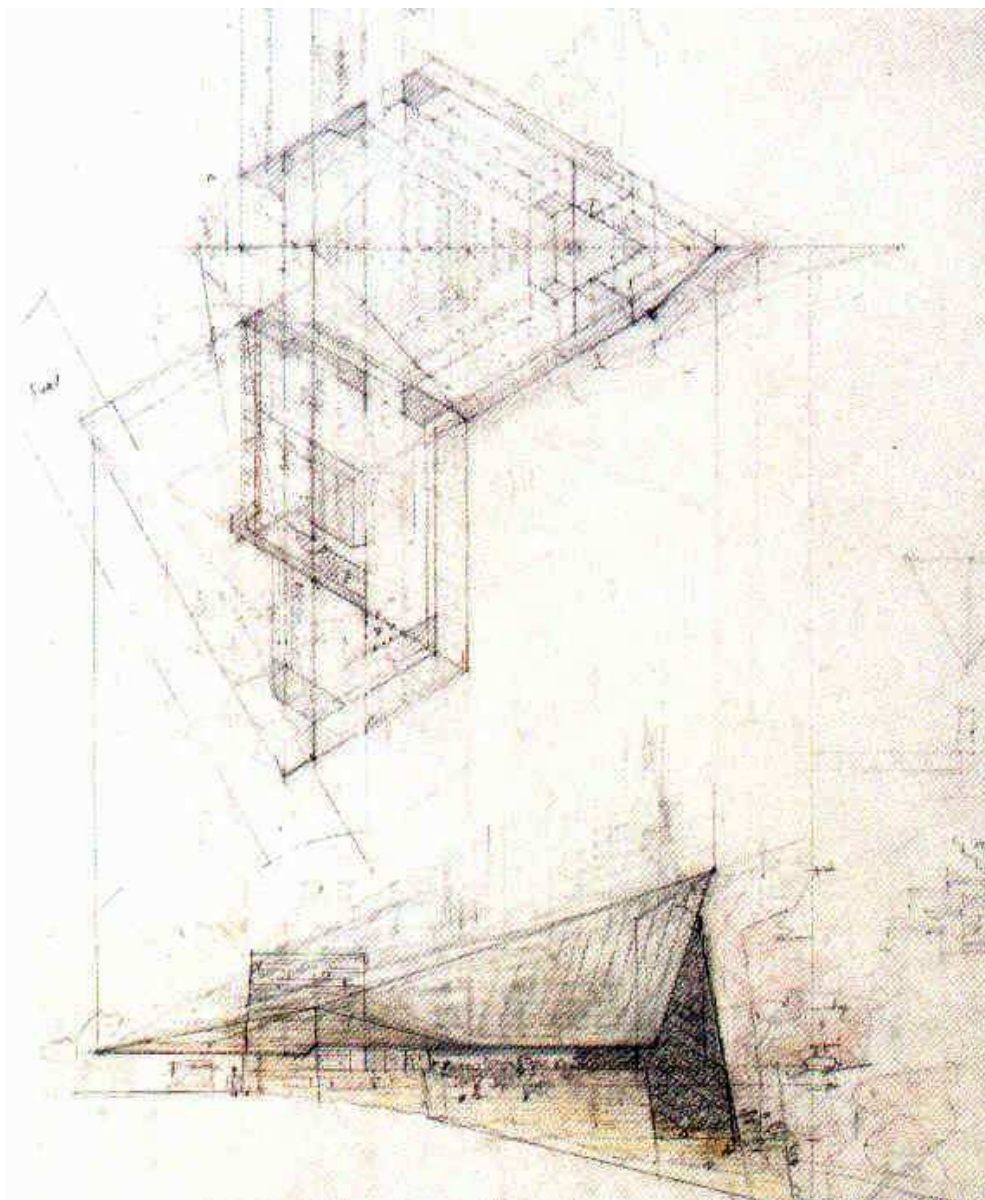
Croquis elevação lateral do projeto preliminar (depois modificado)
